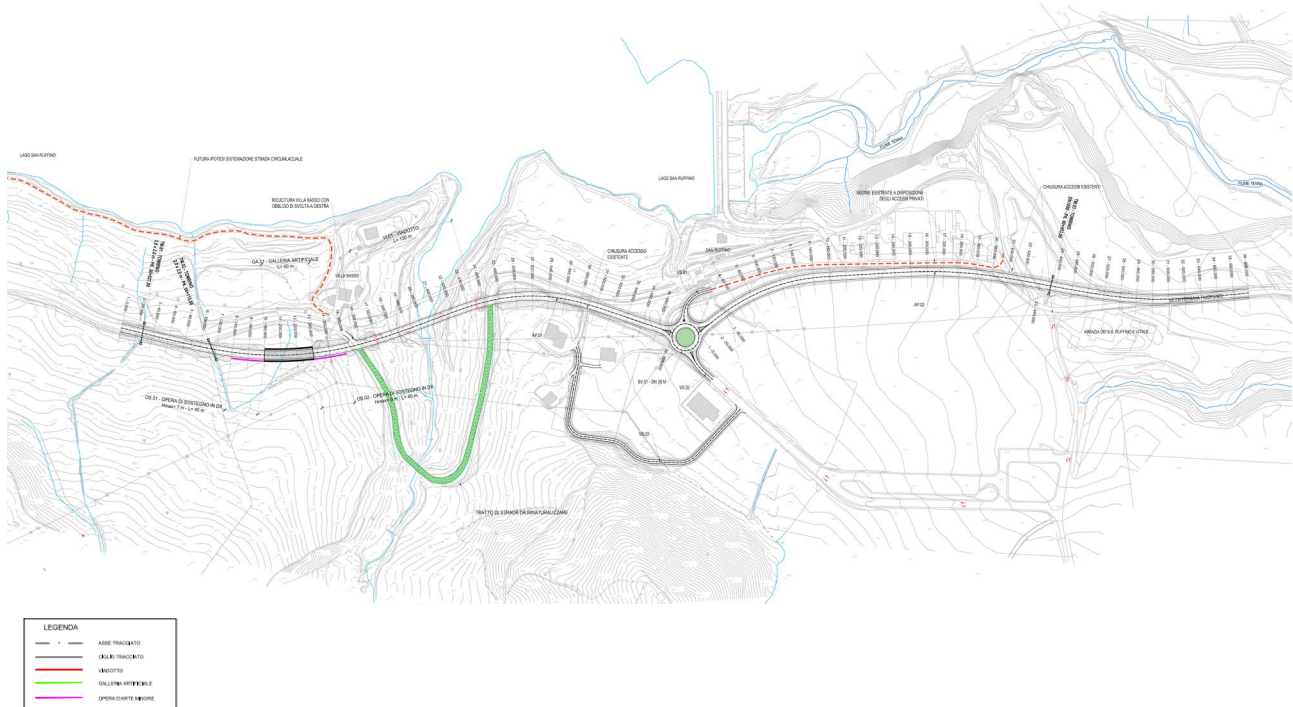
Planimetria di progetto dell'infrastruttura (rif. elaborato T01PS00TRAPP01)
